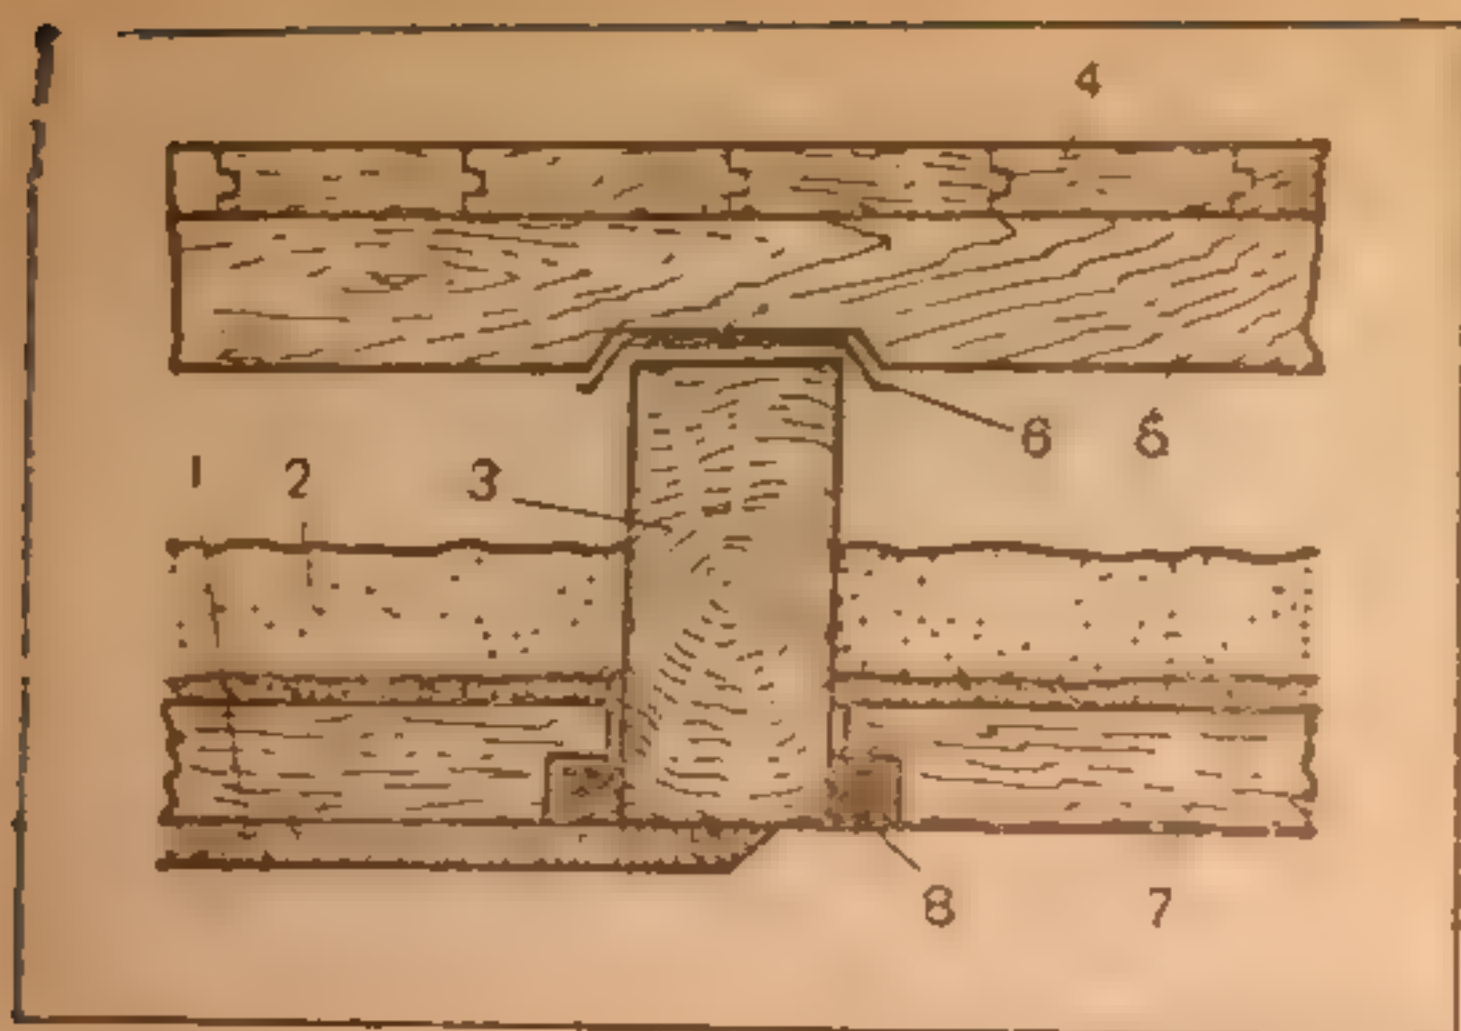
Междуэтажное перекрытие по деревянным балкам (разрез):
